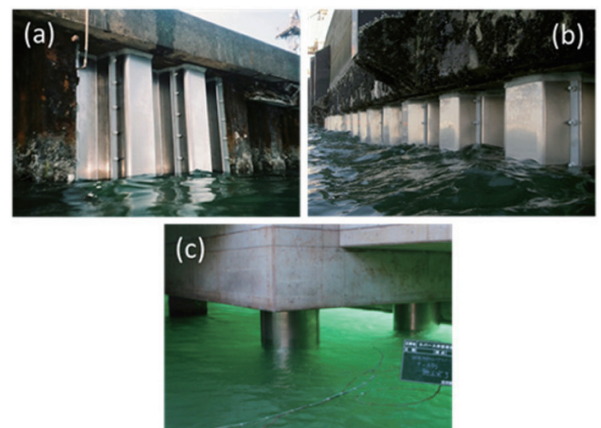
TP工法施工の様子 (a) 釜石, (b) 名古屋, (c) 鹿島
